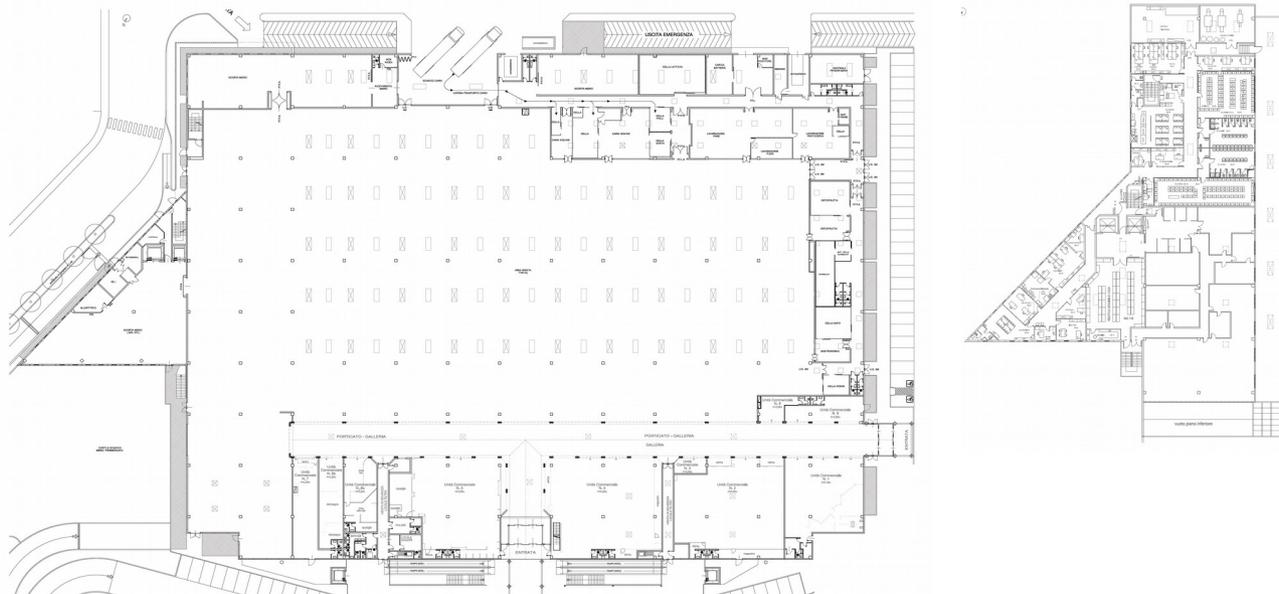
Pianta piano terra e piano primo dello stato di fatto
